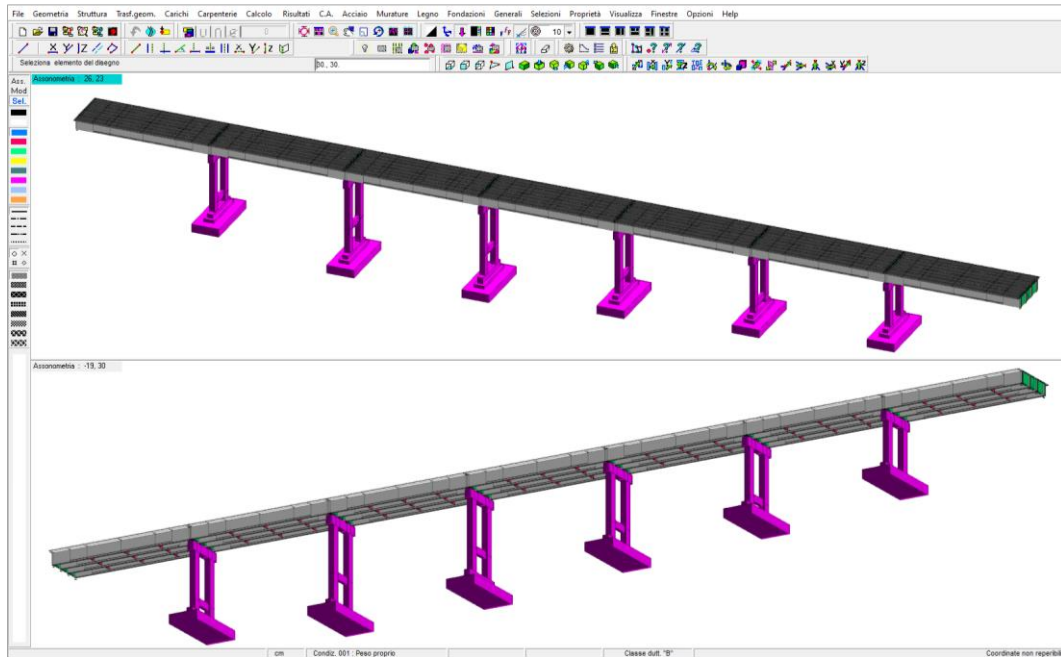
Vista assonometrica nel CAD 3D Strutturale DOLMEN (dall'alto e dal basso)
